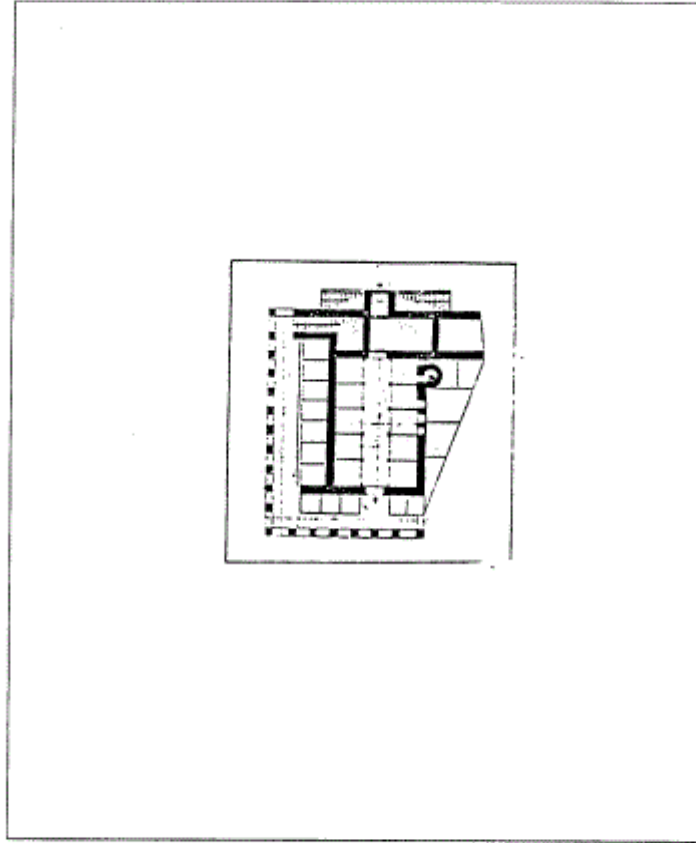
مسقط أفقي لبادستان رستم باشا المعروف ببادستان بورصة في سراييفو
